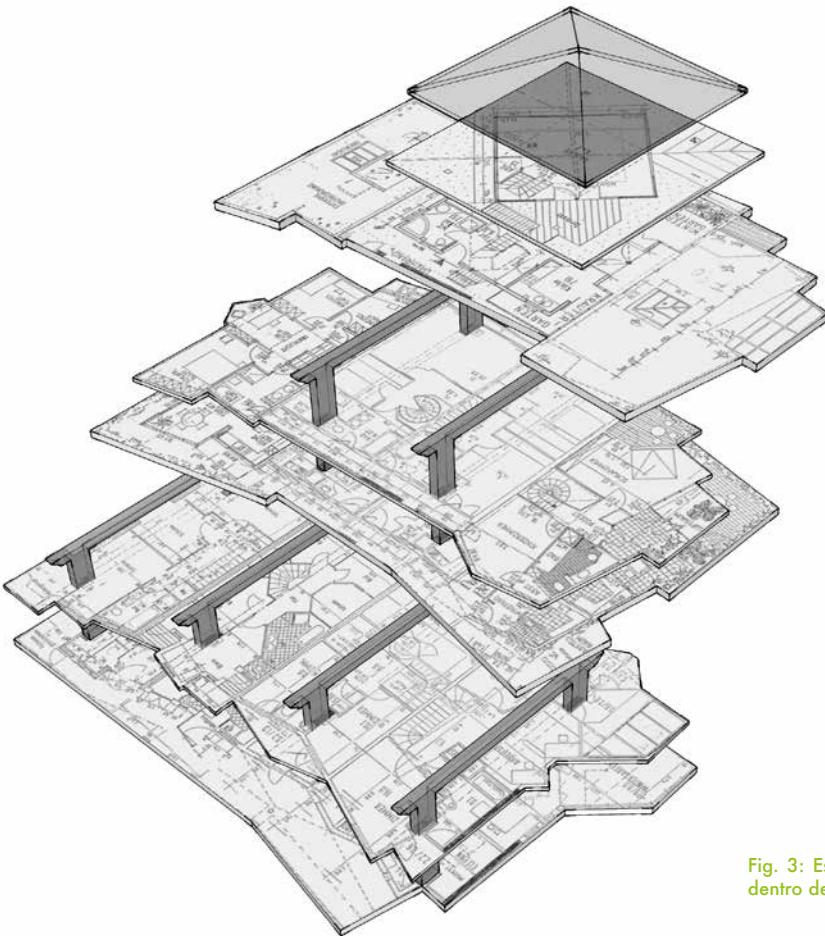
Esquema de plantas arquitectónicas dentro de la estructura de soporte.
